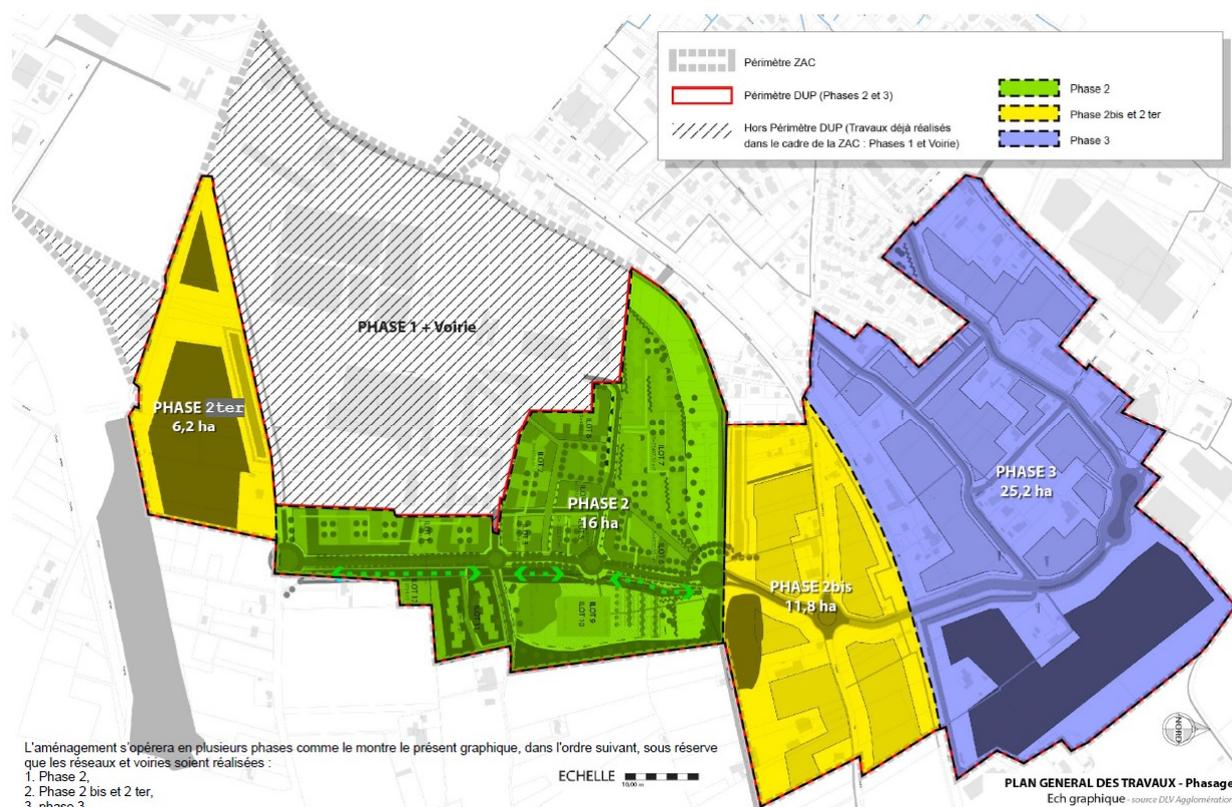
Plan général des travaux -Phasage (extrait du dossier C)
